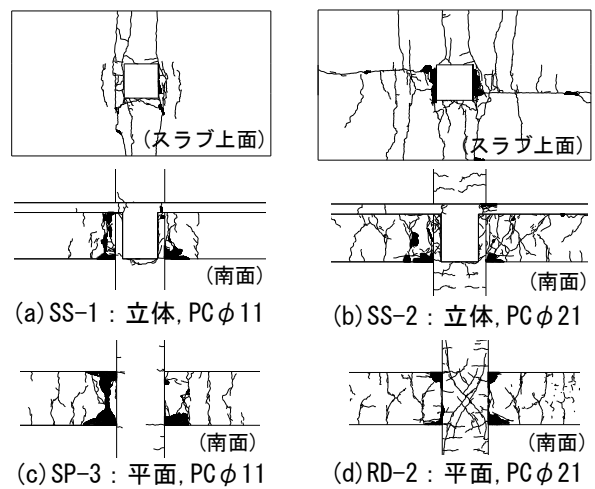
ひび割れ状況(層間変形角4.0%)
